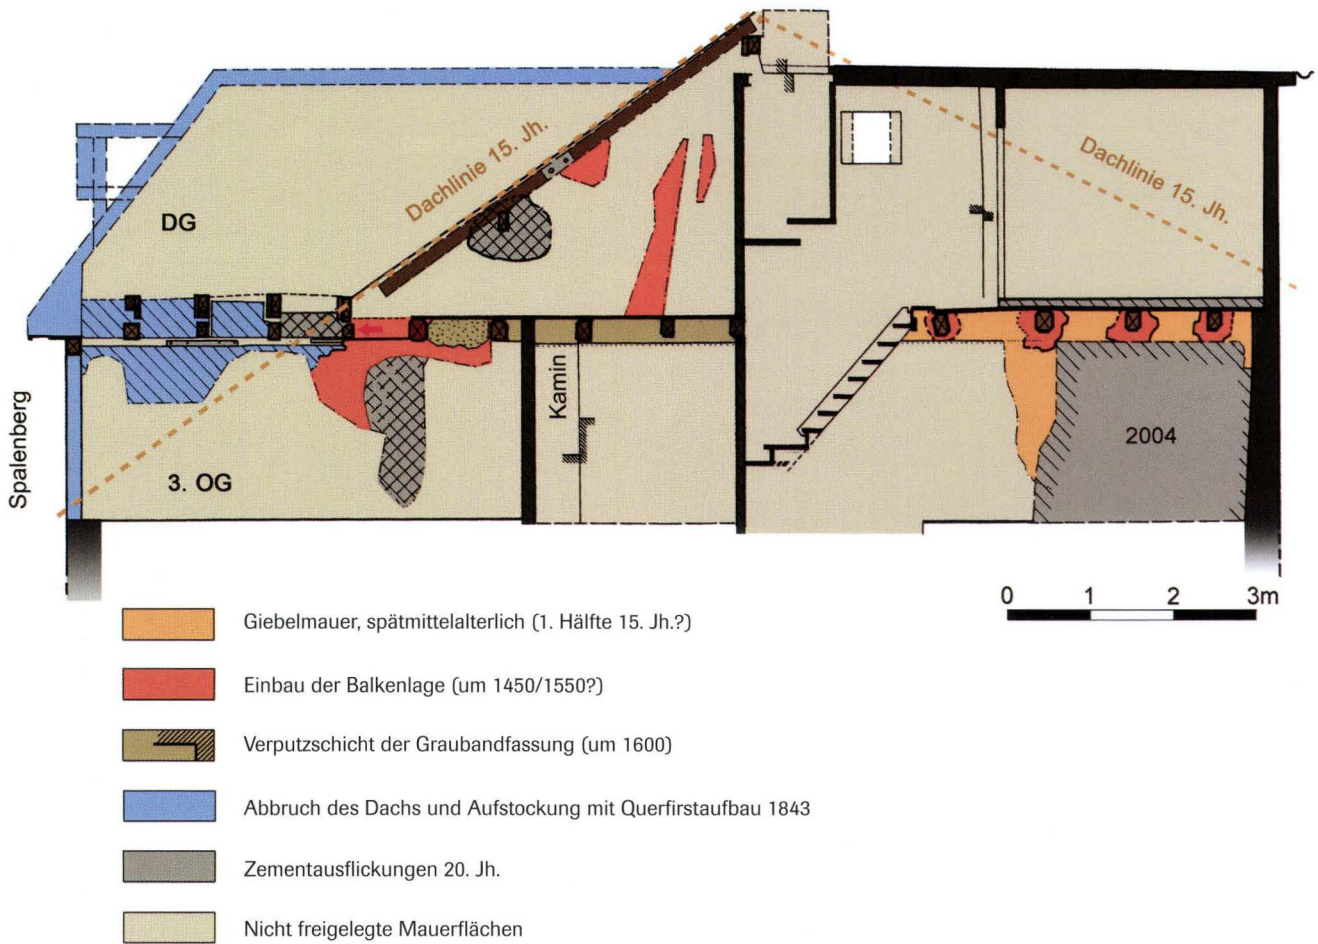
Spalenberg 29 (2004/478). Die Ostbrandmauer im 3. OG und im Dachgeschoss. – Plan: Stephan Tramèr.
